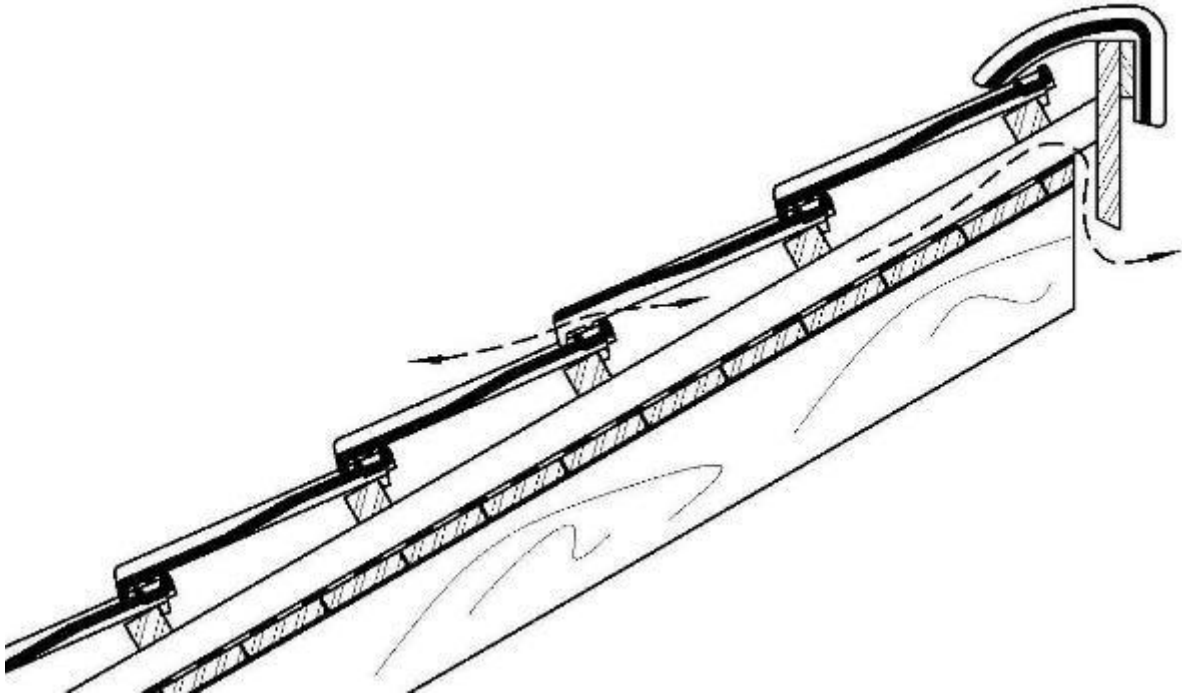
Pultausbildung mit Universal-Pultziegeln
